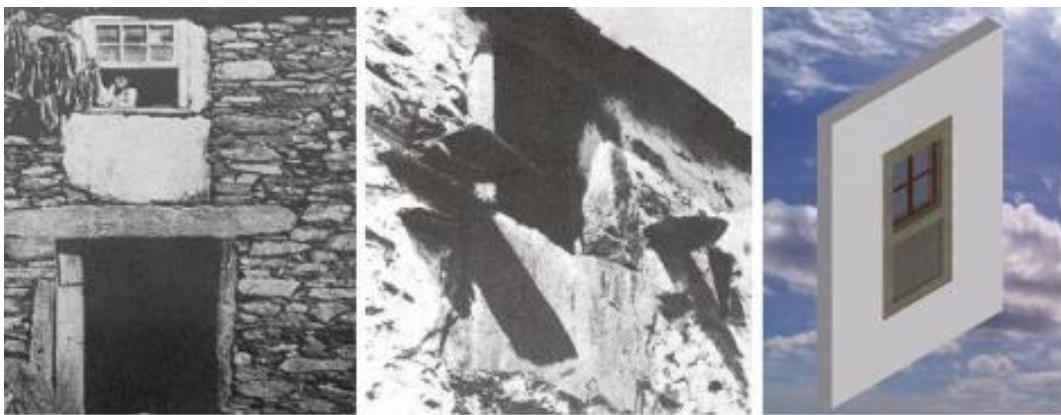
Janelas com parapeito em pedra tradicional com características de captação e armazenamento passivo da energia solar.
